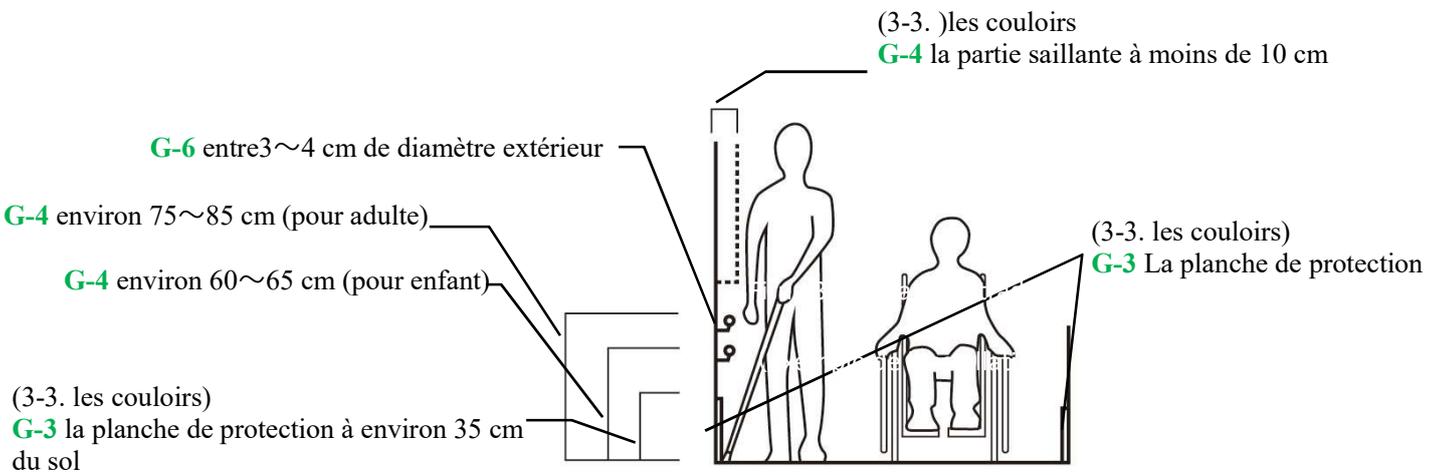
La balustrade(exemple de l'installation sur le mur)
